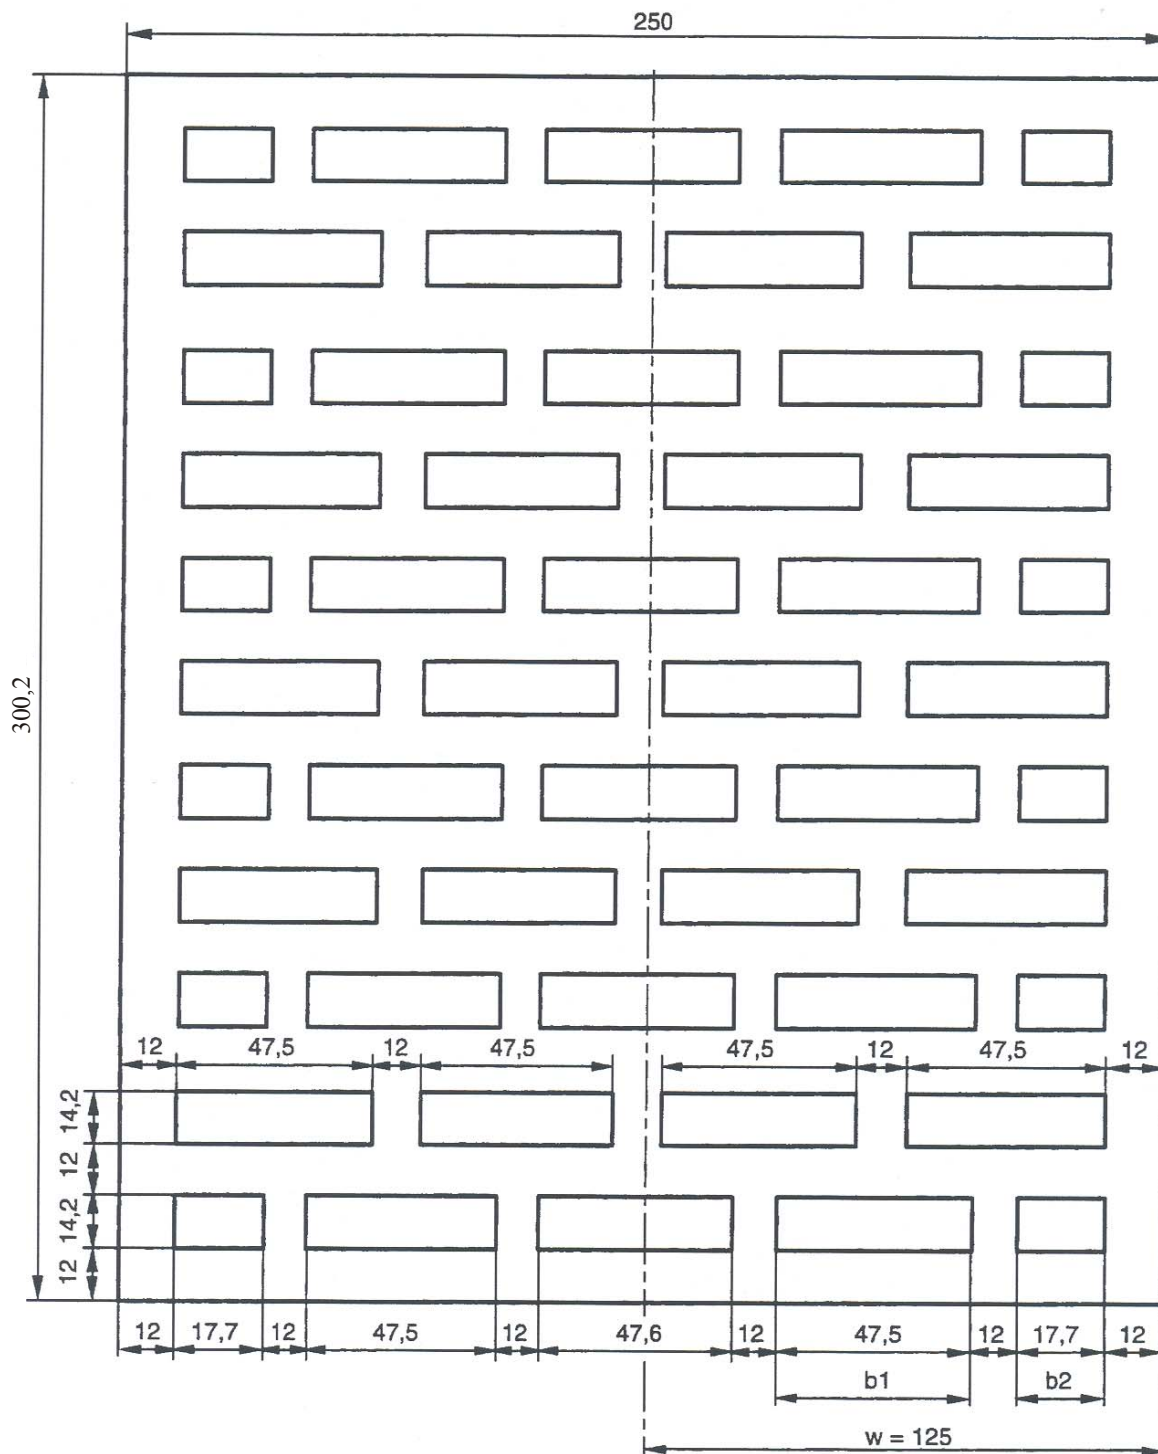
Geometria de um elemento de alvenaria, com perfuração vertical
